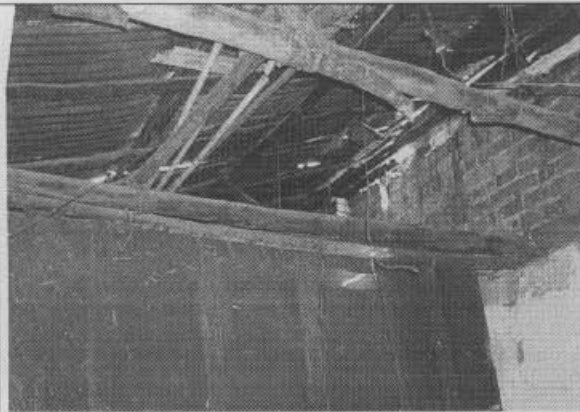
Deterioro de la estructura de cubierta y evidencia de incendio en el sector A del inmueble.
